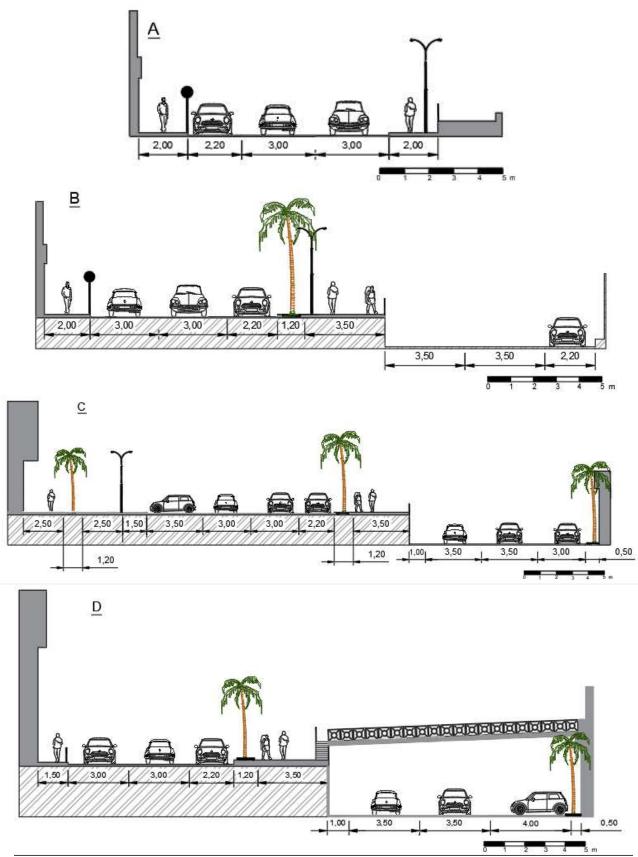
Secciones actuales de la Avenida Marqués de Benicarló y viario interno del puerto. Elaboración Propia
